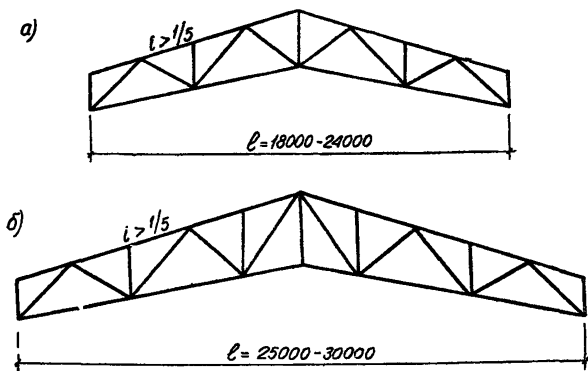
Схемы решетки полигональных ферм с крутым уклоном верхнего пояса
